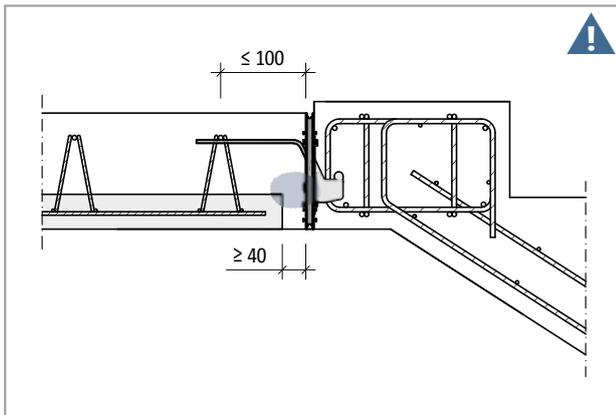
Schöck Tronsole® Typ T: Einbau in Verbindung mit Elementdecken, Druckfuge deckenseitig
